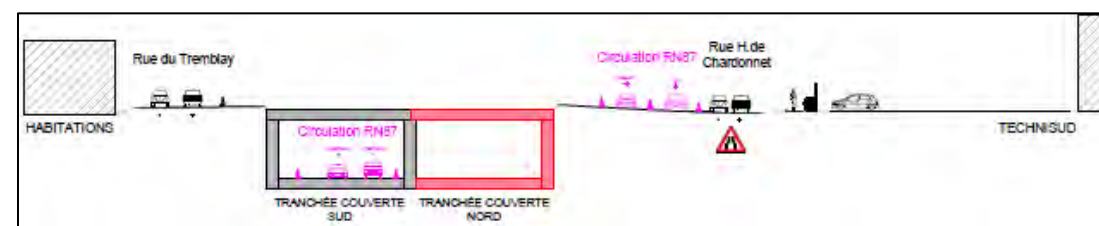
Construction du piédroit nord puis du radier et de la dalle de couverture
